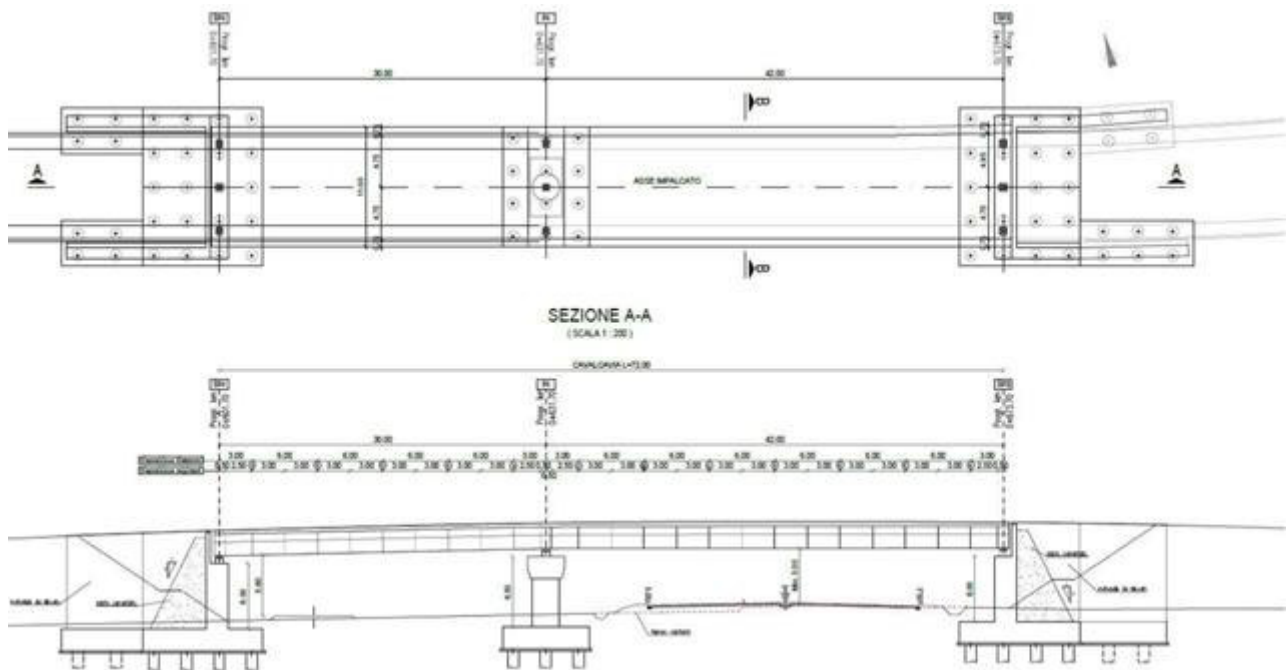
Planimetria e sezione cavalcavia km 5+540
